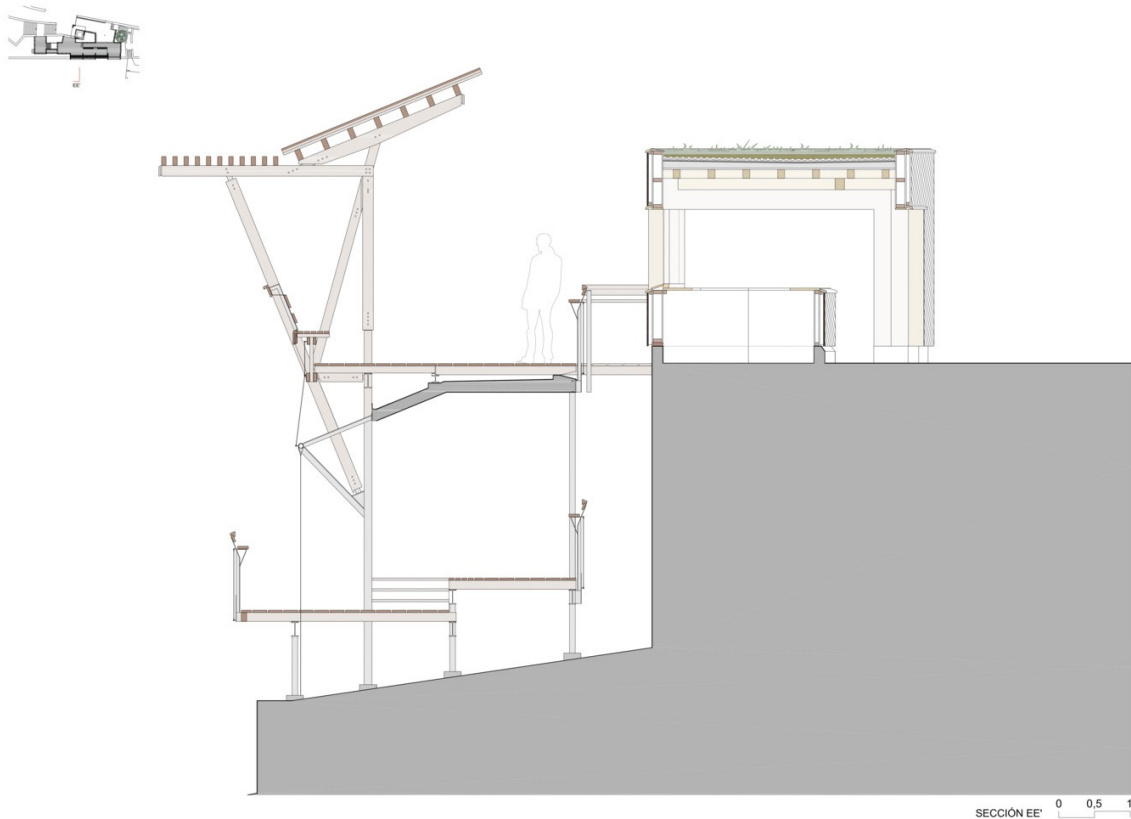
Sección constructiva de la estructura. Se aprecian los diferentes apoyos en el terreno de la estructura metálica, la lámina de hormigón armado de techo del piso inferior y los niveles de acceso.
